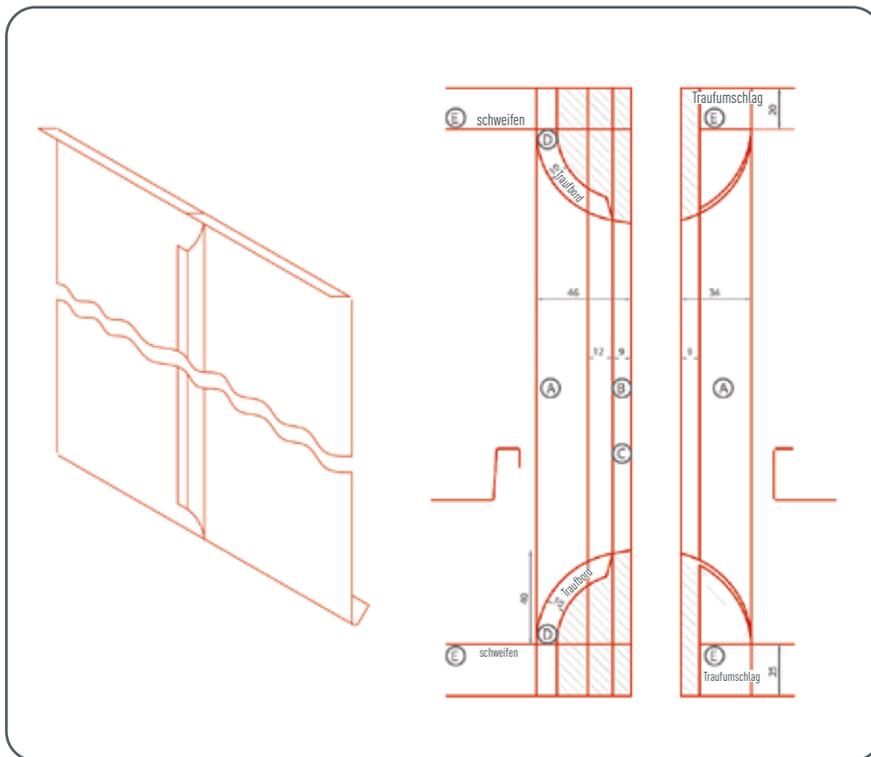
· Detail Stehfalzausläufe bei senkrechter Winkelstehfalzfassade
